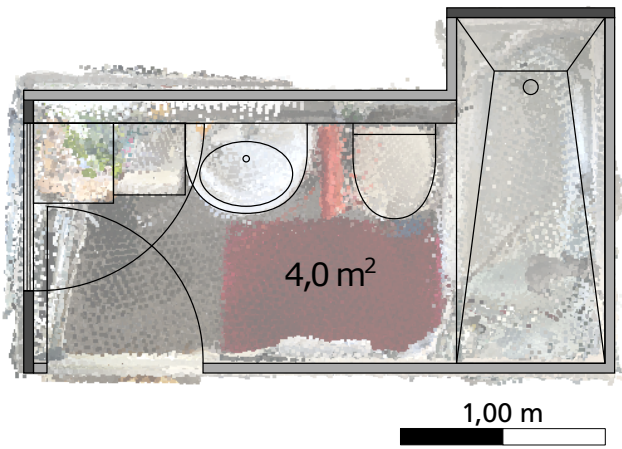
Grundrissdarstellung mit RGB-texturierter Punktwolke eines Badezimmers
